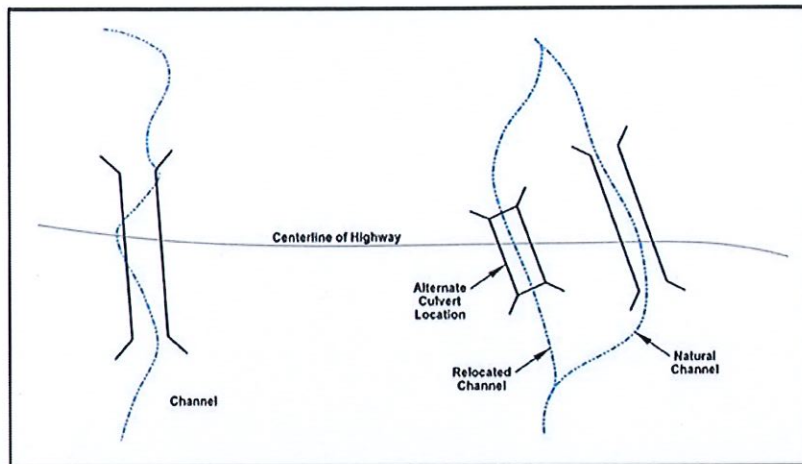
Ejemplo de ubicación de alcantarilla. Fuente FWHA, 2012
